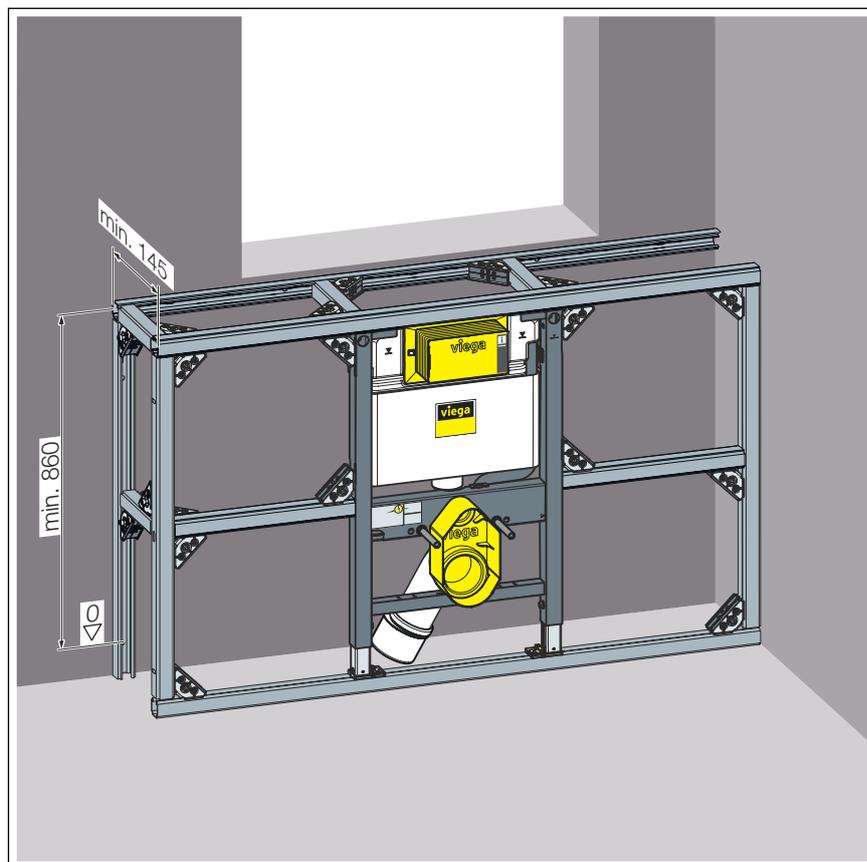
Cotes de montage, hauteur de construction basse (actionnement par l'avant)
